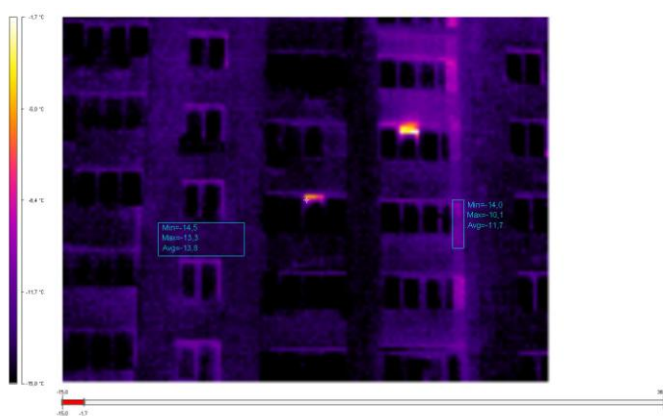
Житловий будинок нової модернізованої серії АПВС К-134 «М» з тепловентильованим фасадом, м.Київ, вул.Закревського, 97-з'йомка тепловізором
